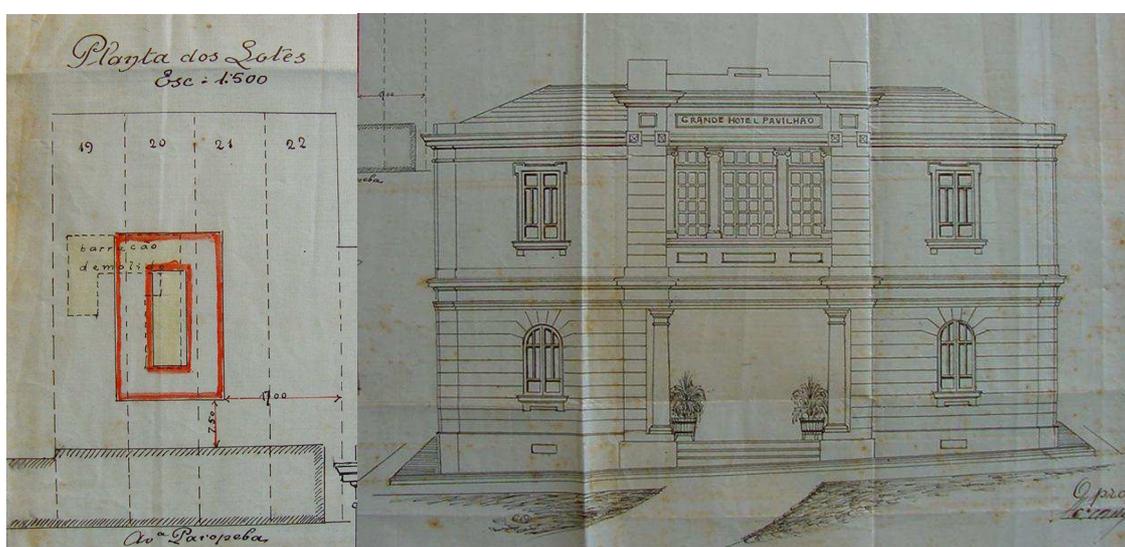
Planta dos lotes e fachada do hotel do Projeto de Luiz Olivieri referente à construção do Pavilhão Central do Grande Hotel, localizado à Avenida Augusto de Lima em 1922. Lote 19, 20 e 21, Quarteirão 10, Seção 3.
